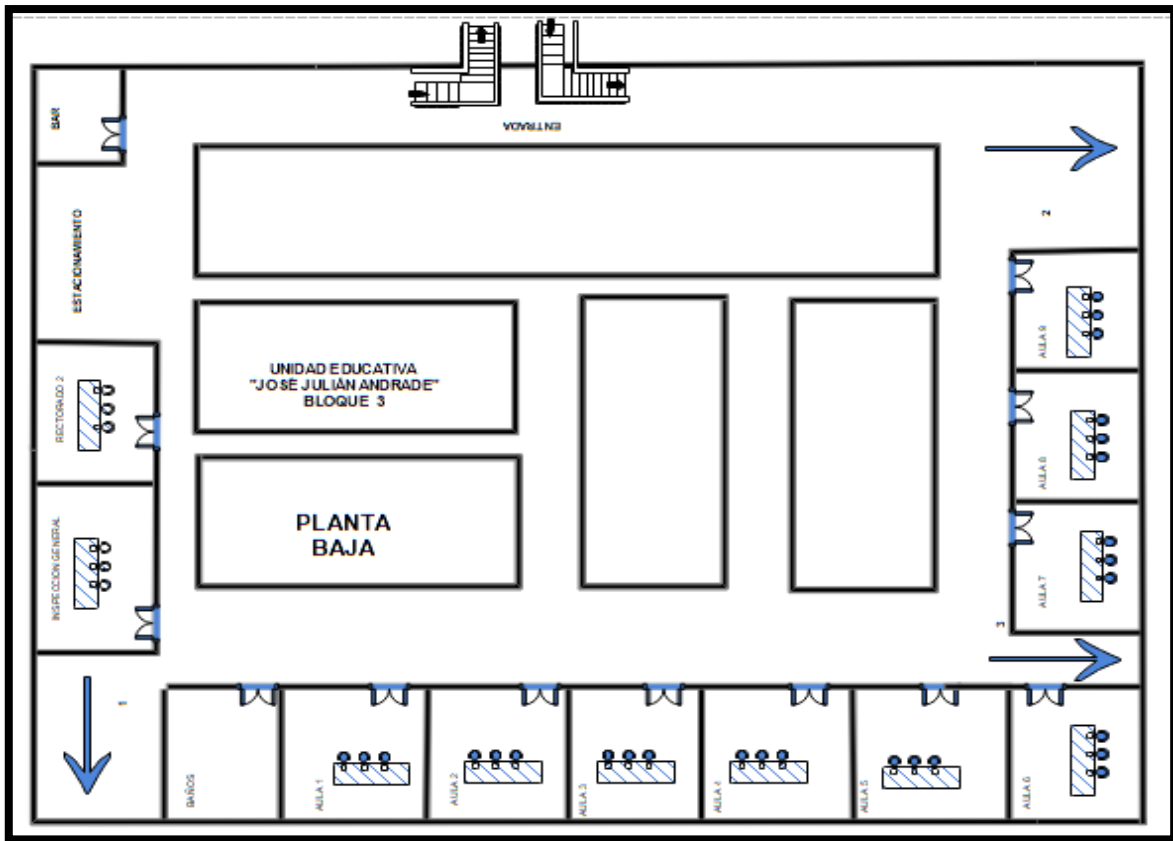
Plano de la estructura del bloque 3, planta baja de la institución
